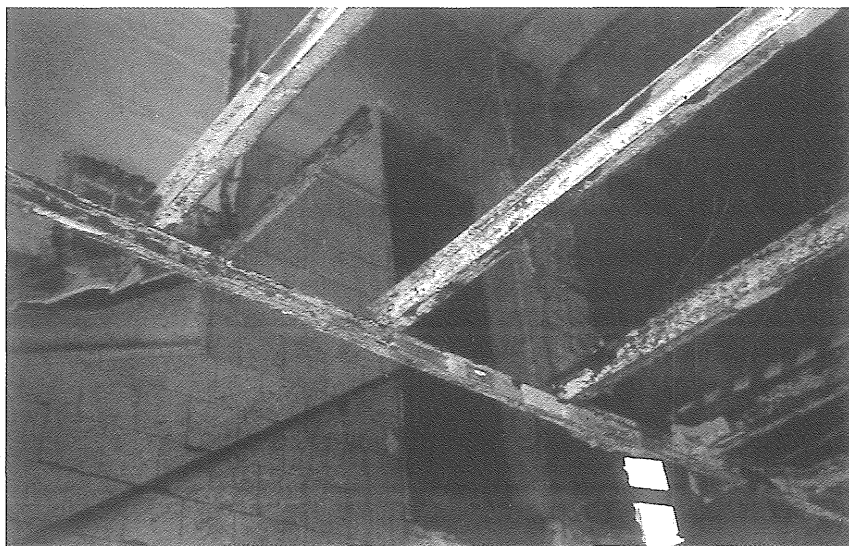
14. Refuerzos metálicos de vigas: refuerzos de secciones con perfiles I y U.
